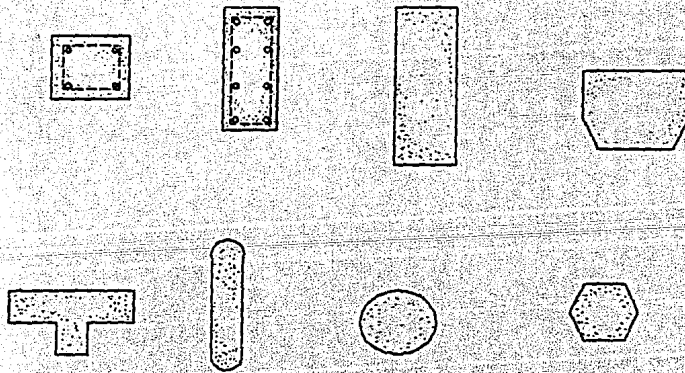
SECCIONES PARA COLUMNAS DE CONCRETO.
